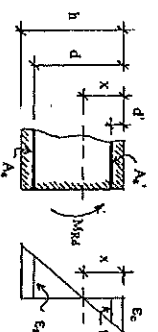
Flexão normal simples de uma viga de concreto armado.
